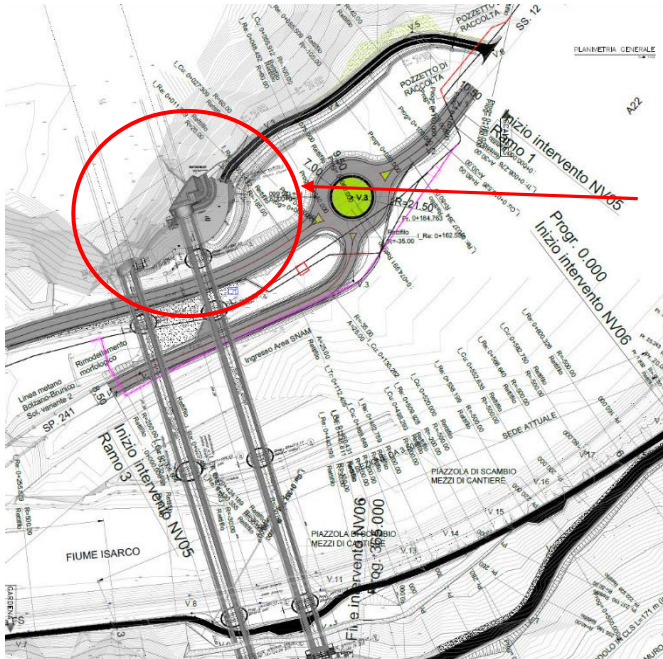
Planimetria Ponte Isarco con scala di emergenza all’imbocco sud della galleria Scaleres verso il piazzale di emergenza
